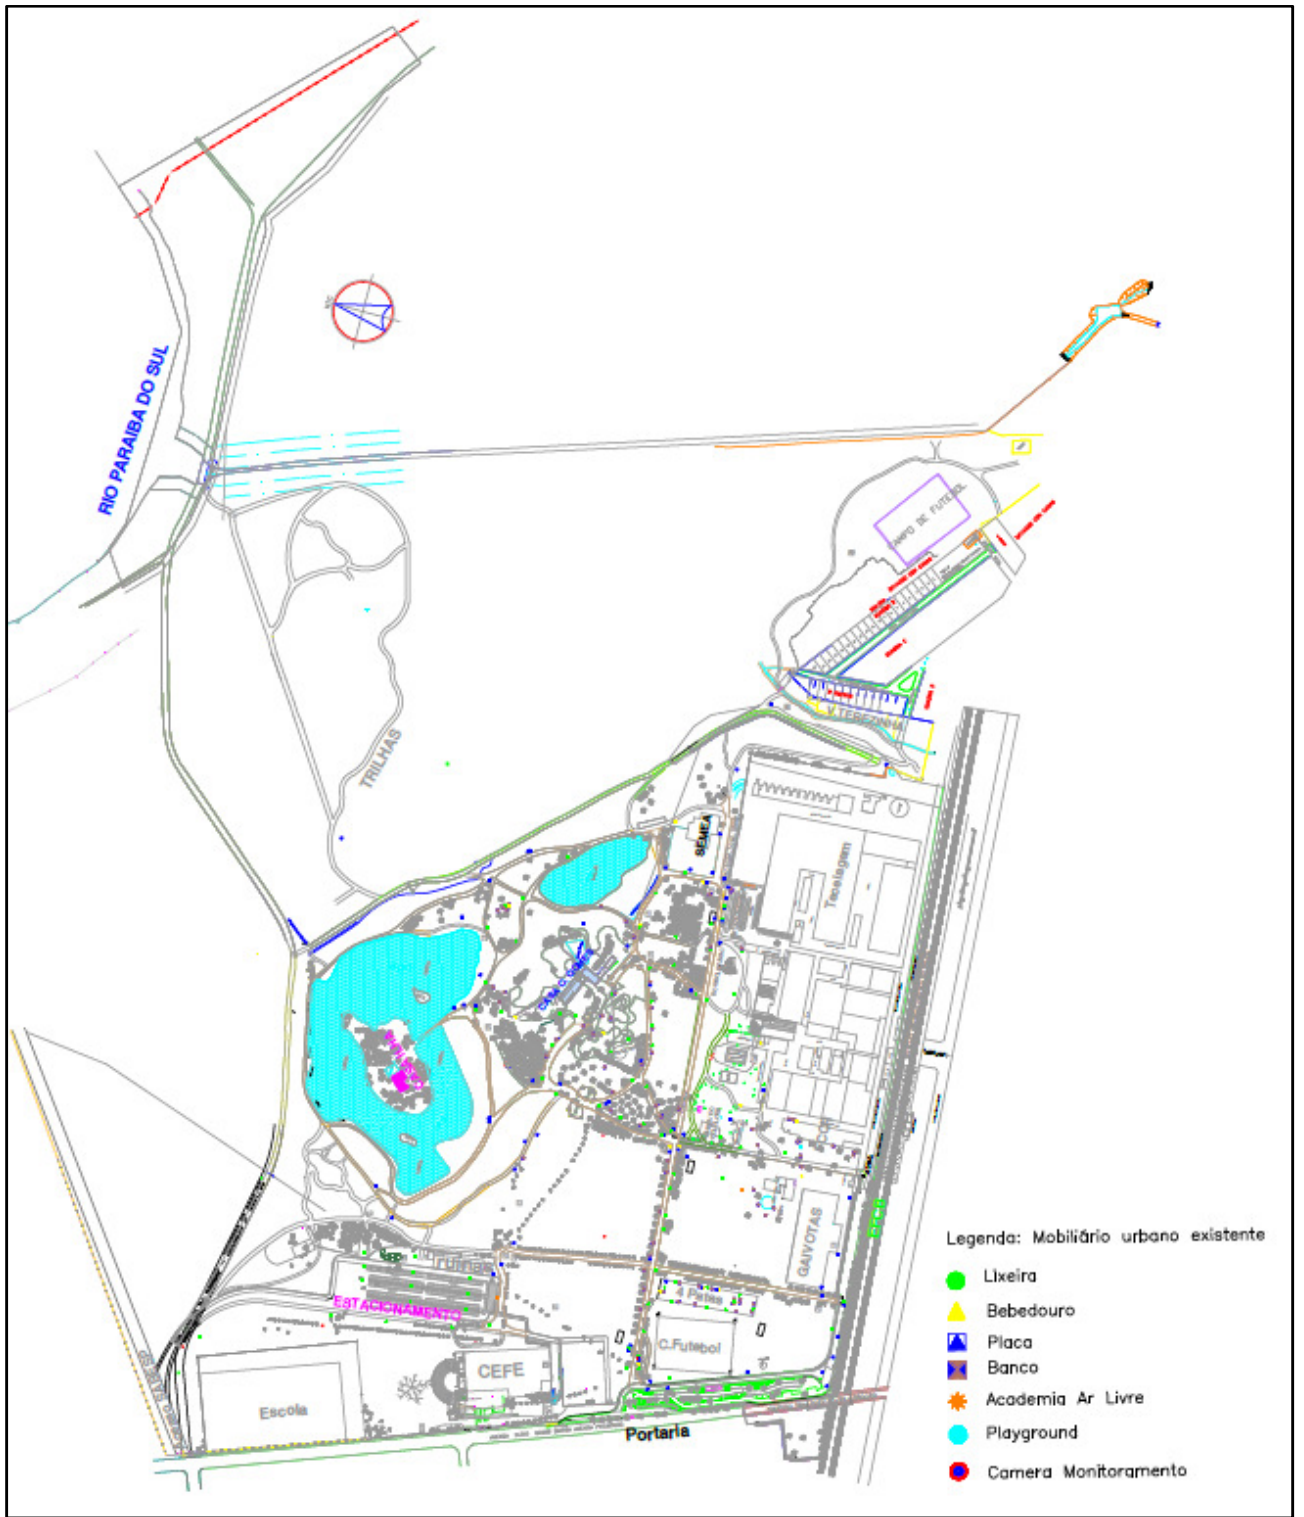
Planta com levantamento do mobiliário urbano existente
